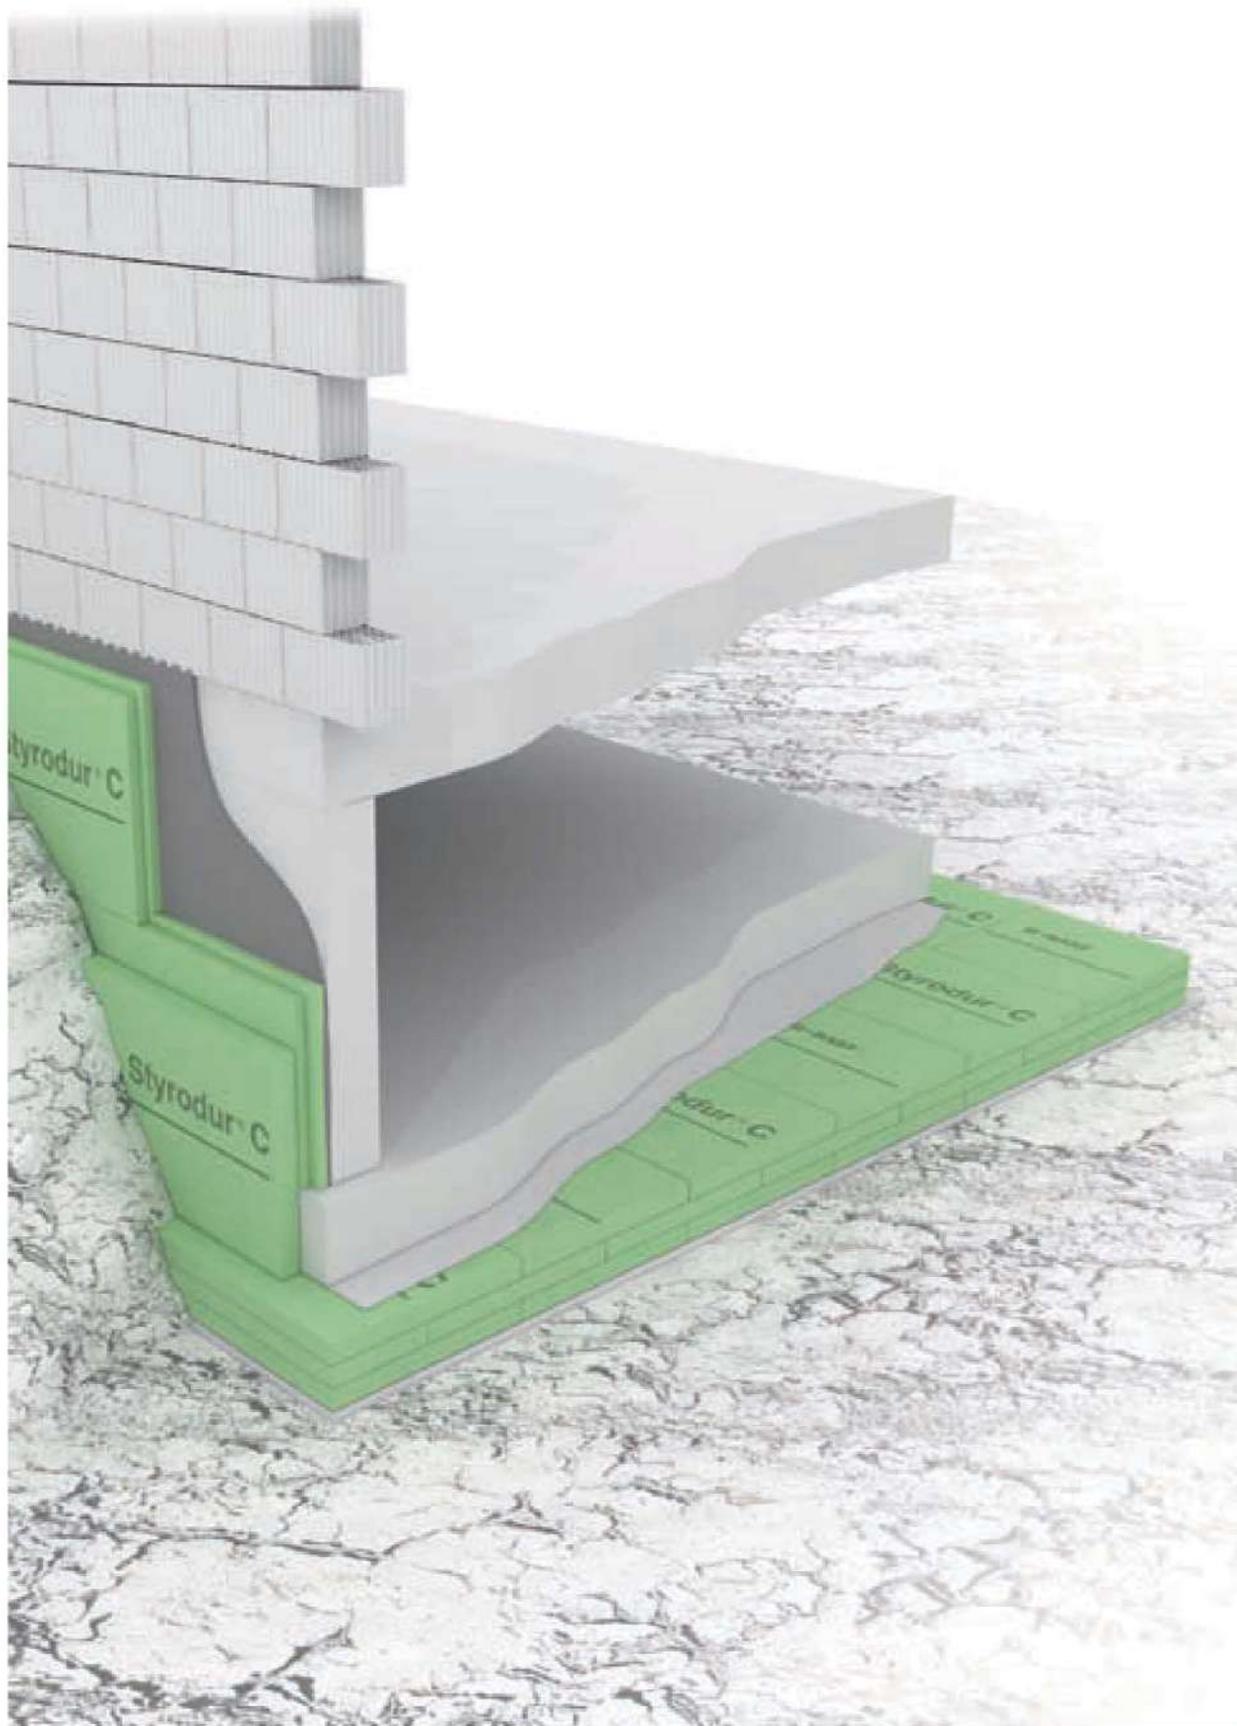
Gracias a su elevada resistencia a la compresión, Styrodur® C está especialmente indicado para el aislamiento perimetral y de losas de cimentación.
